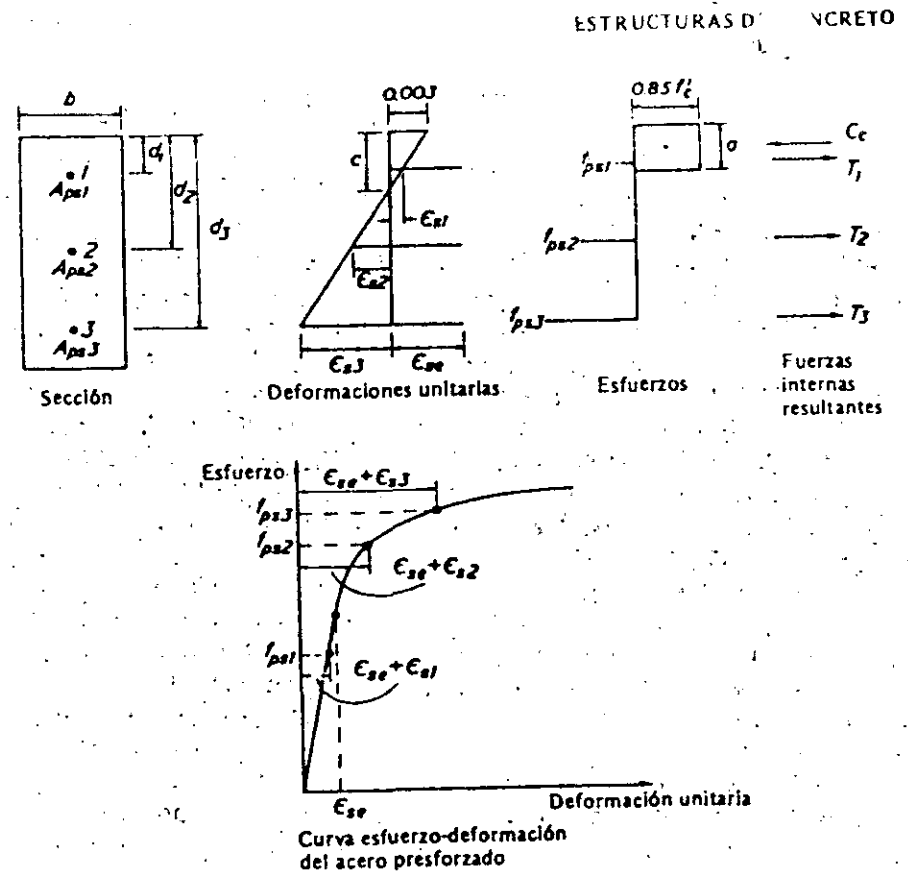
Sección de concreto presforzado al alcanzarse la resistencia a flexión.
